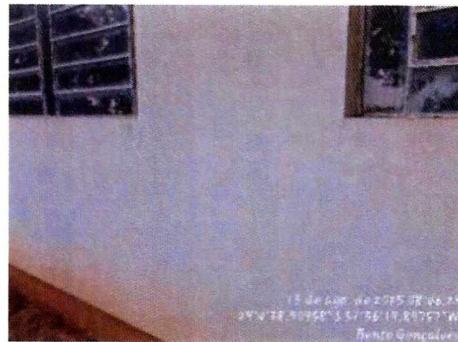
Fissuras na alvenaria dos fundos
